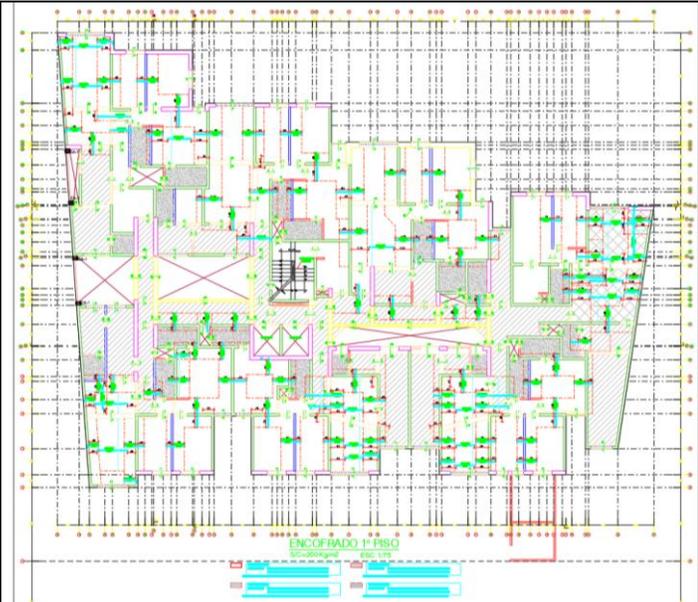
Plano de encofrados. Fuente: Elaboración Propia
